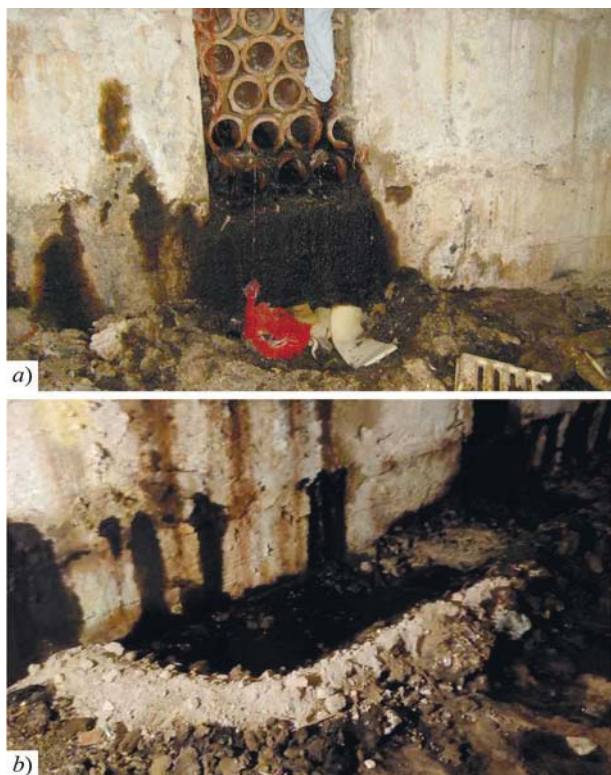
Нафтопрояви у підвалі будинку № 12 / Oil shows in the basement of building No.12
